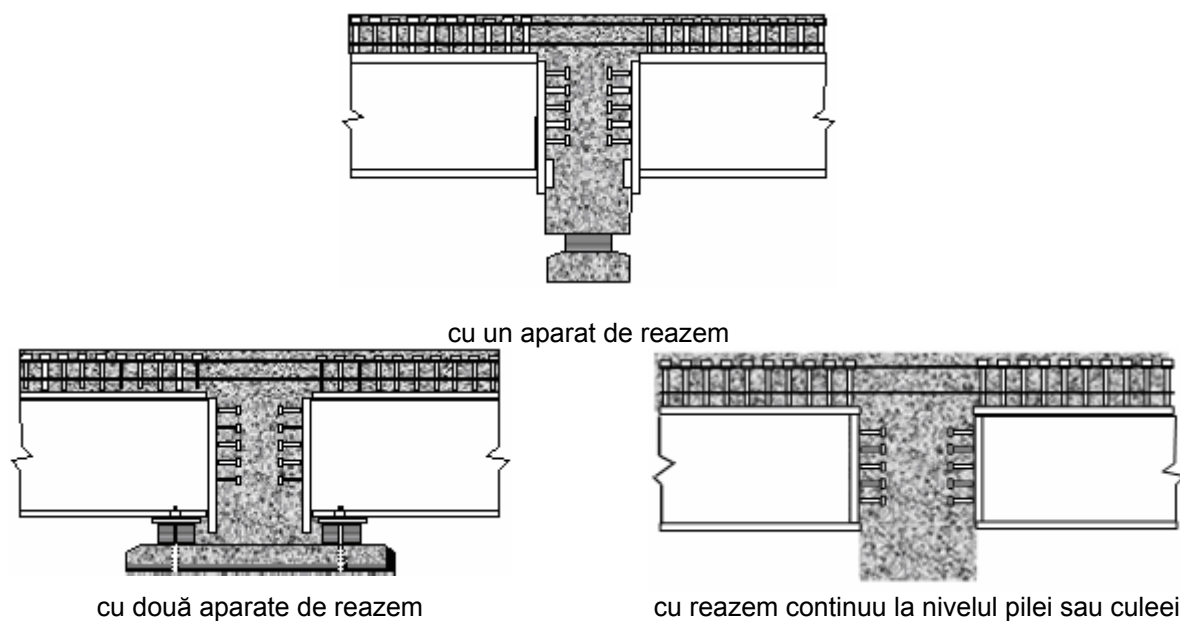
Îmbinare cu placă de capăt și gujoane în grindă transversală de beton armat
